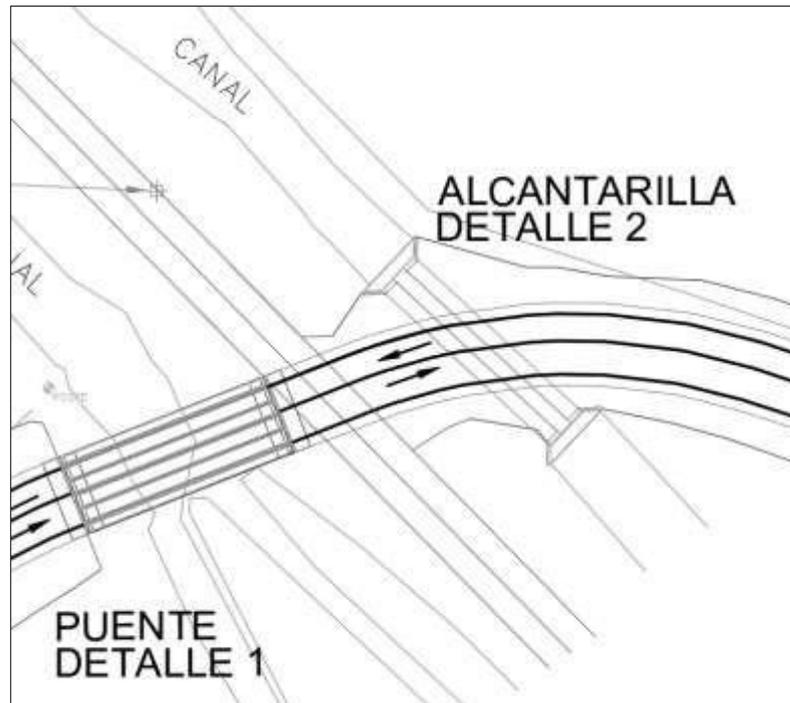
Detalle de Ubicación y Diseño de Alcantarilla Proyectada
